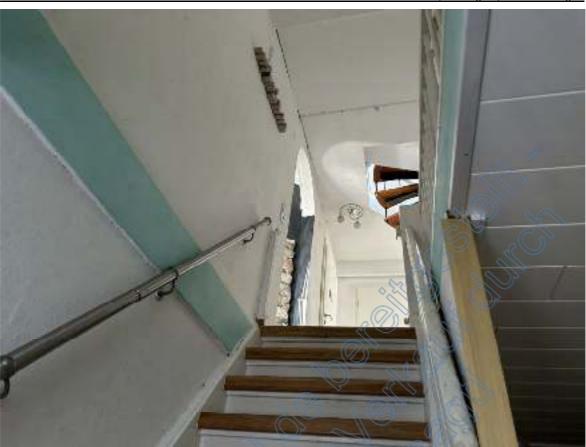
Ausschnitt – Treppe Richtung Flur im Dachgeschoss (Wohnhaus EG Richtung DG).
